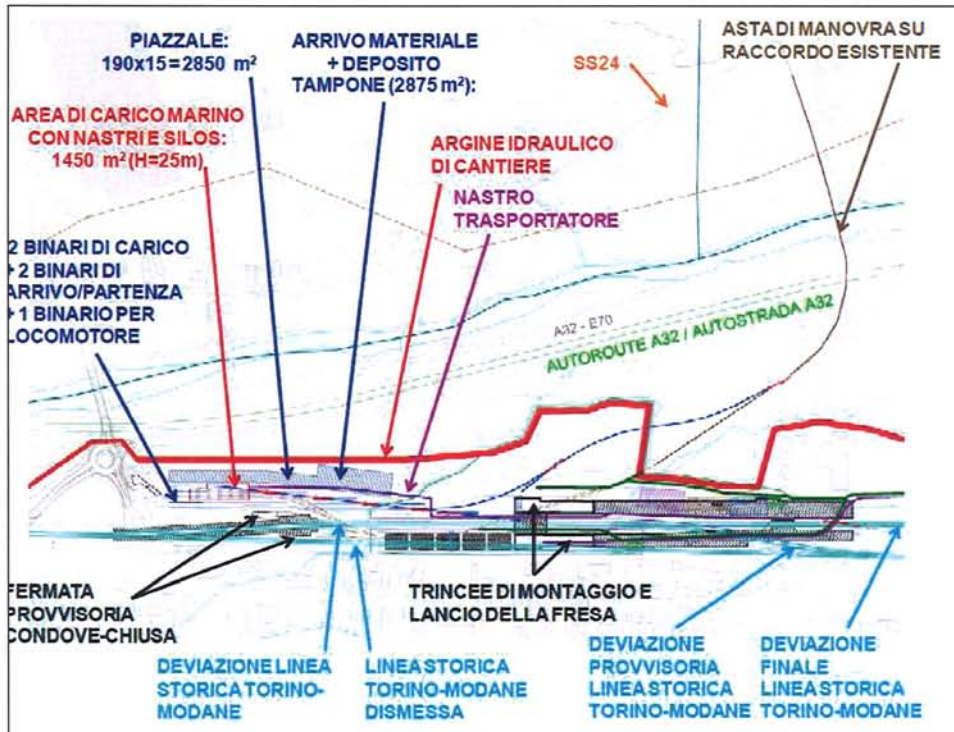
Area di carico di Piana delle Chiuse LTF: stralcio planimetrico
